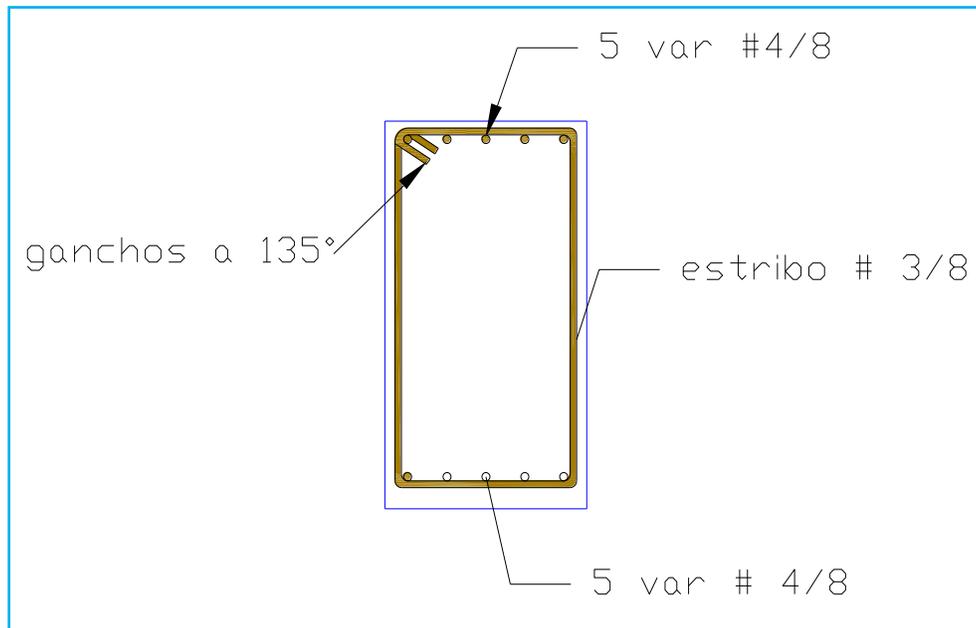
esquema de la distribución del acero para la trabe en los últimos 2.4 m.
